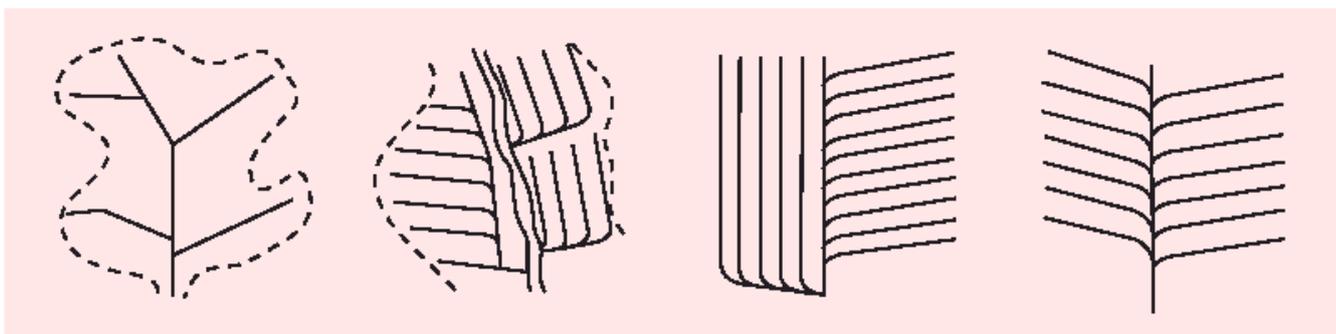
Alcune disposizioni tipiche dei tubi drenanti
